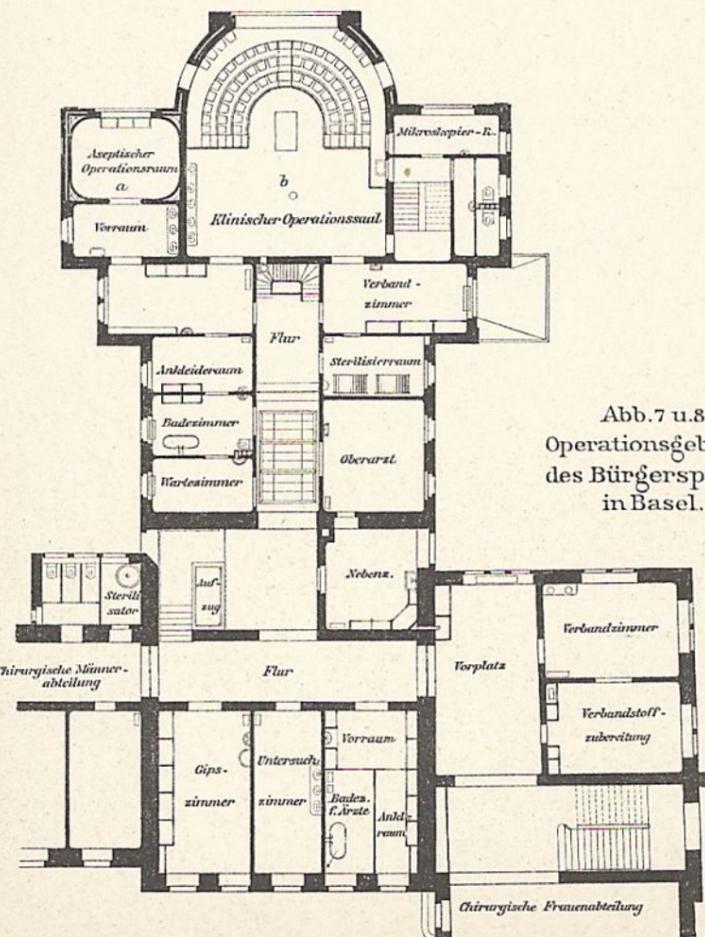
Grundriß des I. Stockwerks. 1: 333 1/3.
